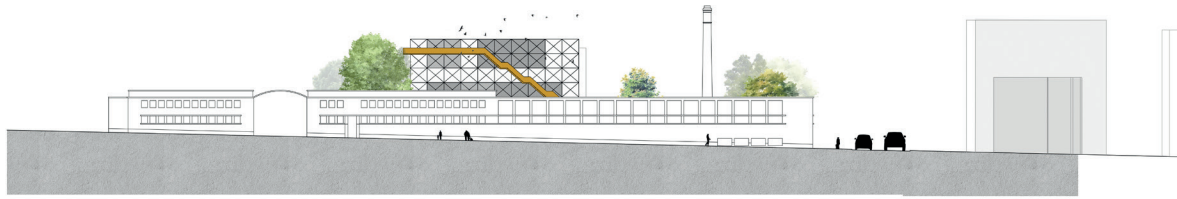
Alçados exterior Nascente da Fábrica Barros, Avenida D. Infante Henrique. Realizado em CAD pela autora.
